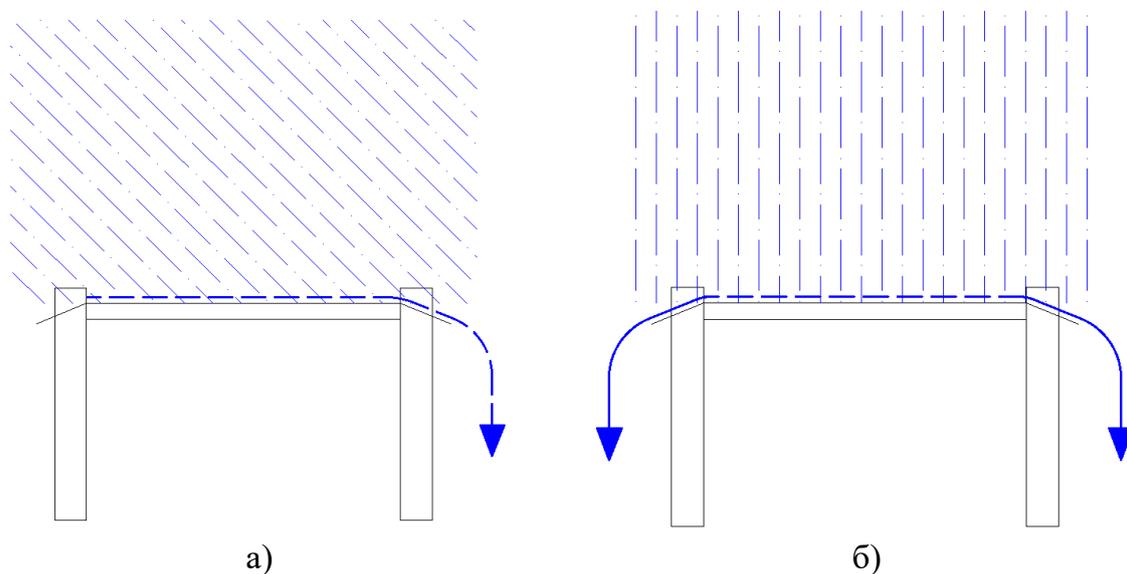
Наружное неорганизованное водоотведение на плоской крыше
